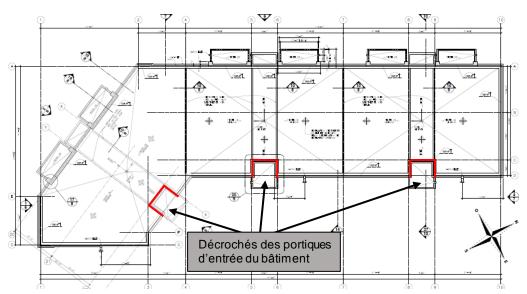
Plan du toit de l'immeuble [...] Source : Groupe McKinley-Beaubois S.E.C., modifiée CNESST
